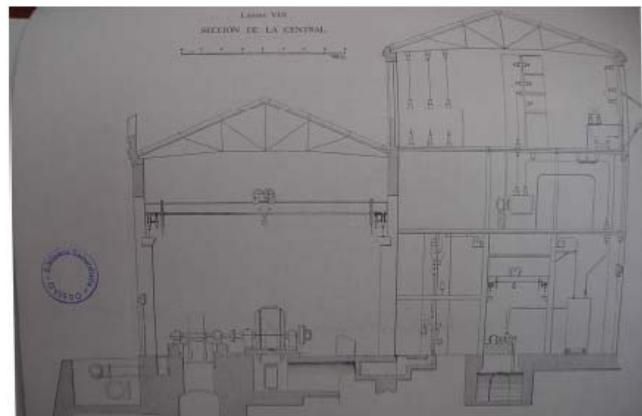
Edificio de la Central Generadora. (F. Archivo HC) [6]. Bâtiment de la Centrale Génératrice. (F. Archives HC) [6]
